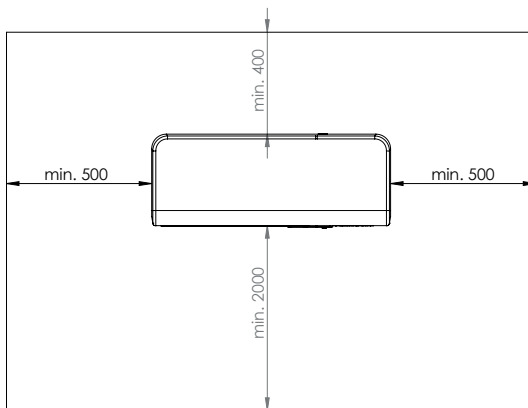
Mindestabstände für das Außengerät der Wärmepumpe. Abmessungen in mm
